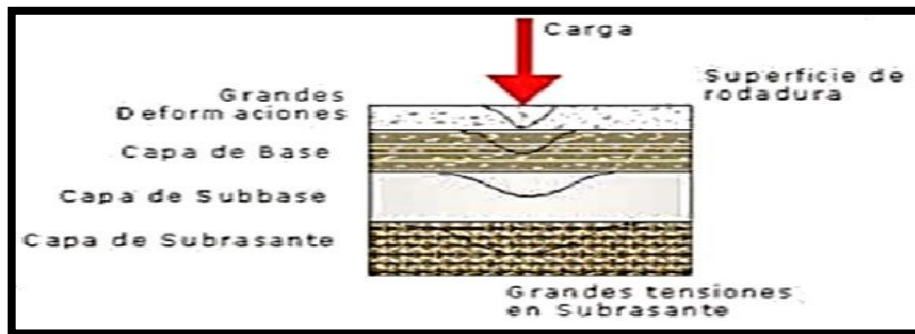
Comportamiento de la estructura del pavimento flexible a las cargas de tránsito.
